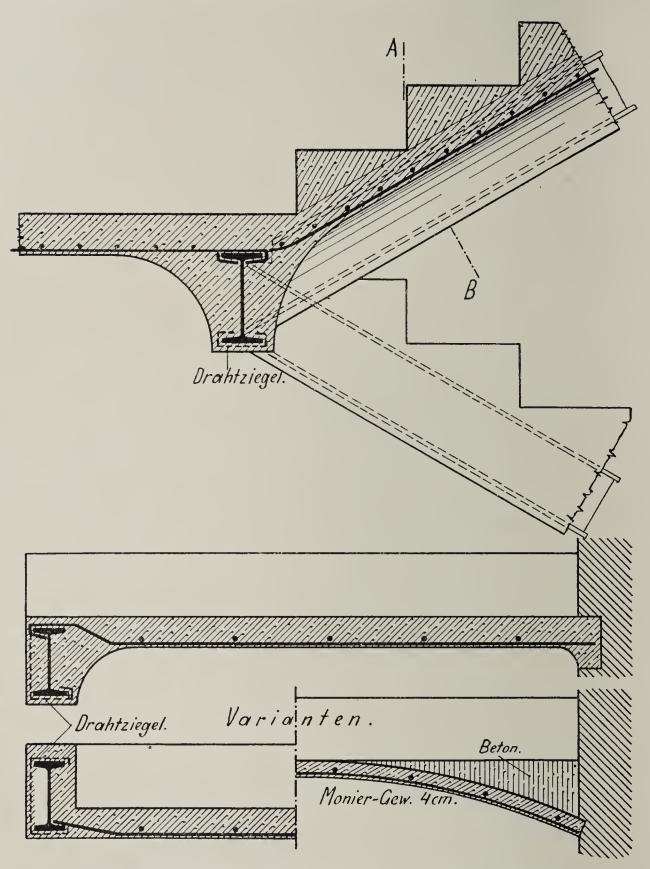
bis 221. Moniertreppen mit eisernen Wangen.
